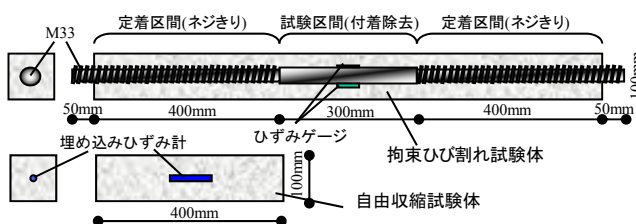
拘束ひび割れ試験体および自由収縮試験体の詳細
